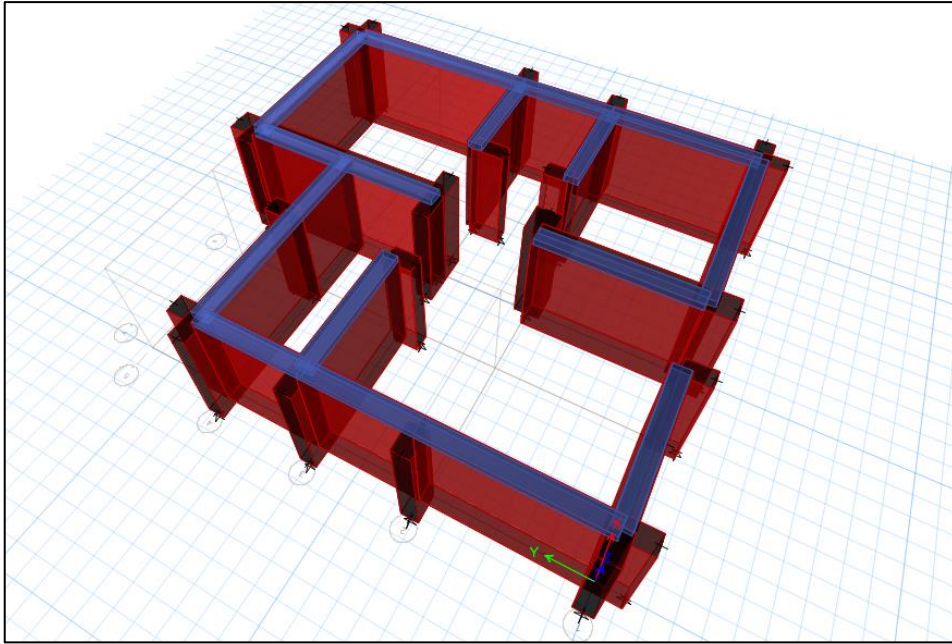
Modelado de la estructura extruida donde se muestra de color azul la viga collar y color rojo los muros de adobe. Fuente: Elaboración propia.
